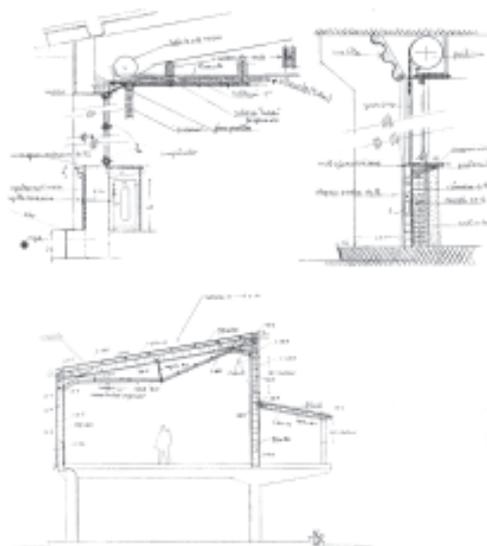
Instituto Laboral. Detalles constructivos y sección.
